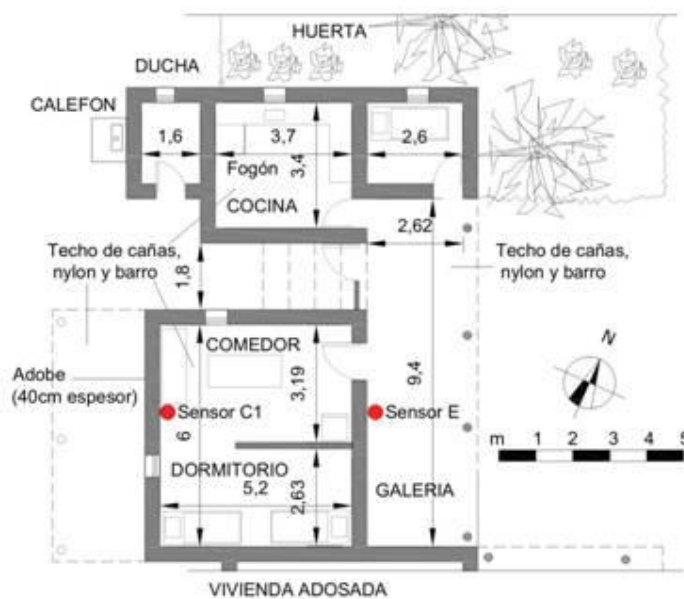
Planta y vistas de la vivienda monitoreada V1. Ubicación de sensores C1 y E.
